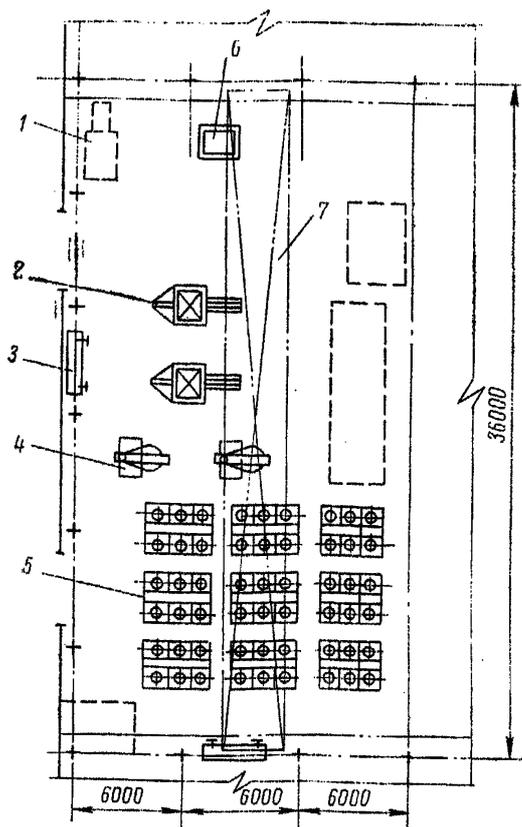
Ремонтно-монтажная площадка пролета флотации. Общая площадь ремонтно-монтажной площадки—648 м², площадь, обслуживаемая краном—544 м²:
